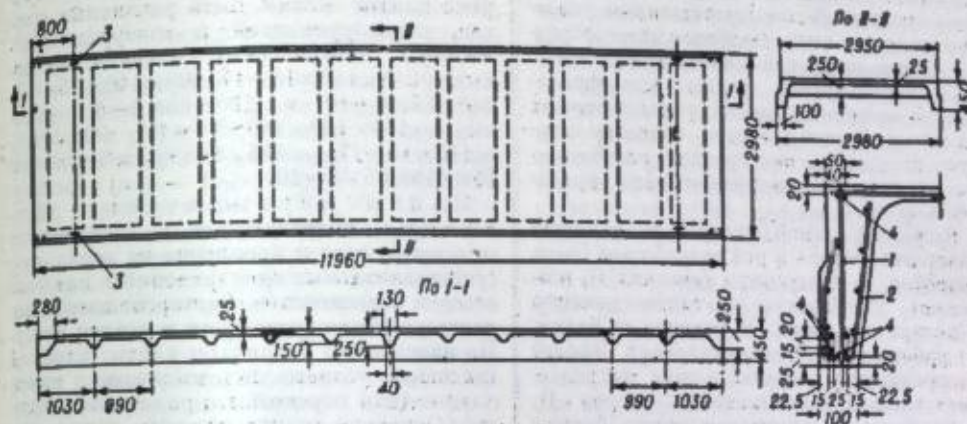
Конструкция предварительно напряженной крупнопанельной плиты покрытия размером 12 м × 3 м: 1 — плоский каркас; 2 — оградительная сетка; 3 — монтажные петли для подъема; 4 — привальная арматура.
